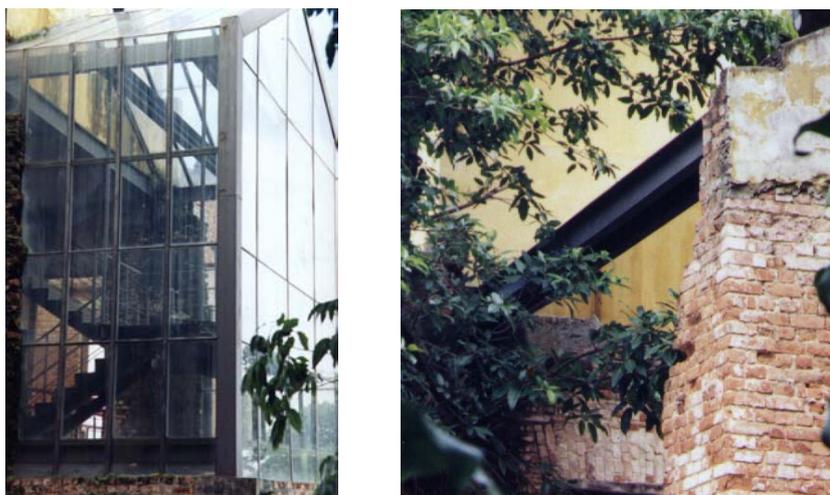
Perfis U, um de costas para o outro, utilizado em vigas e perfis U soldados formando perfis caixa utilizados em pilares.
